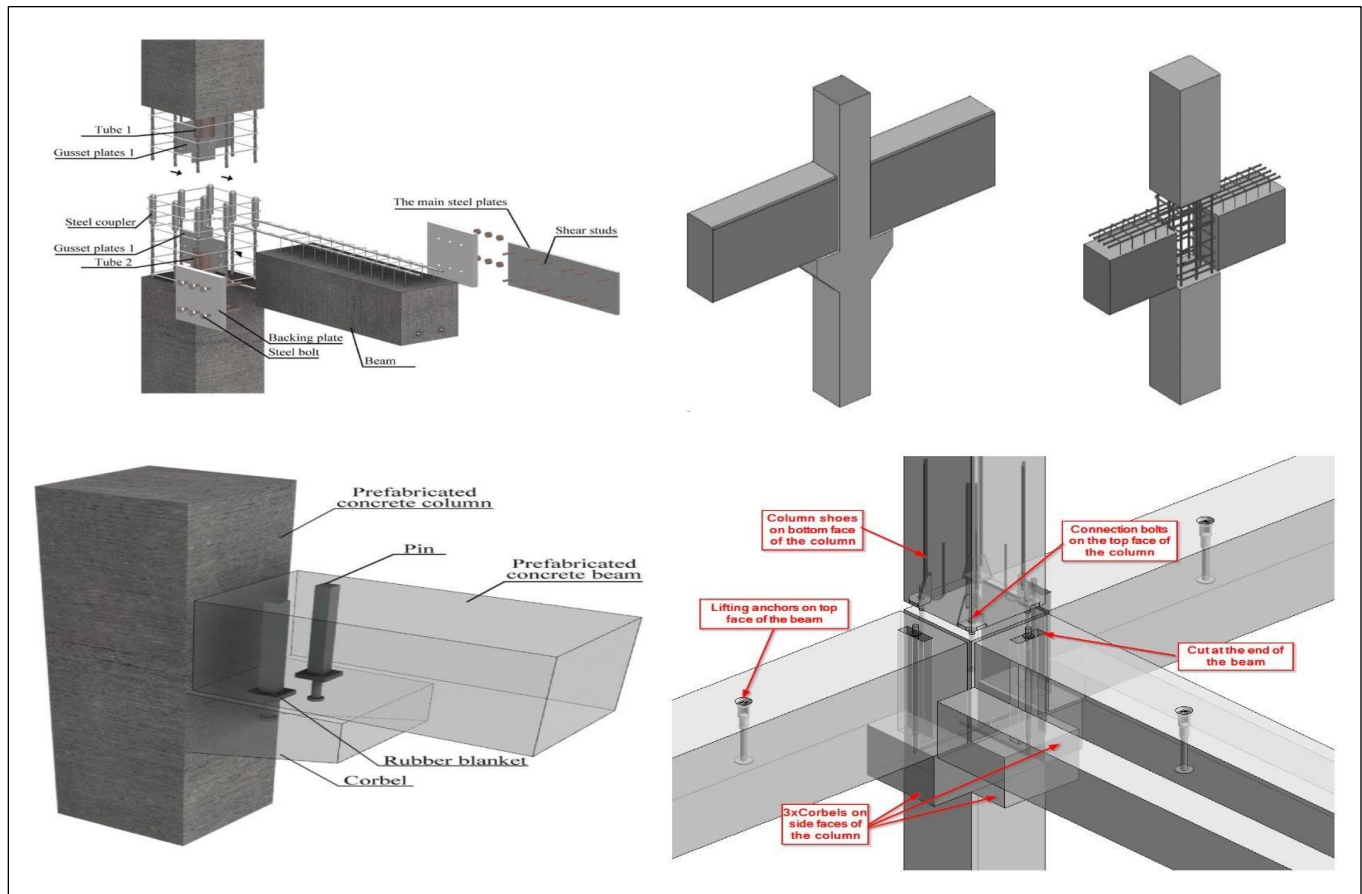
Détails des assemblages poteaux-poutres [27].
